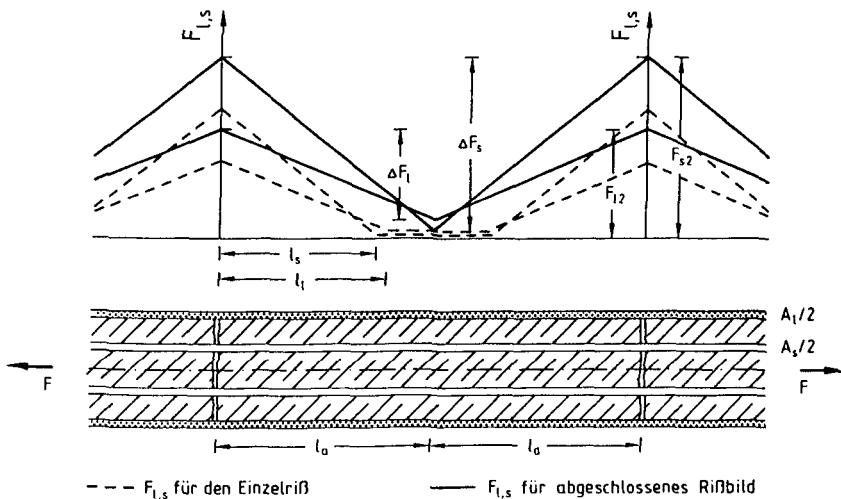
Zugkräfte beim laschenverstärkten Betonkörper mit Innenbewehrung
